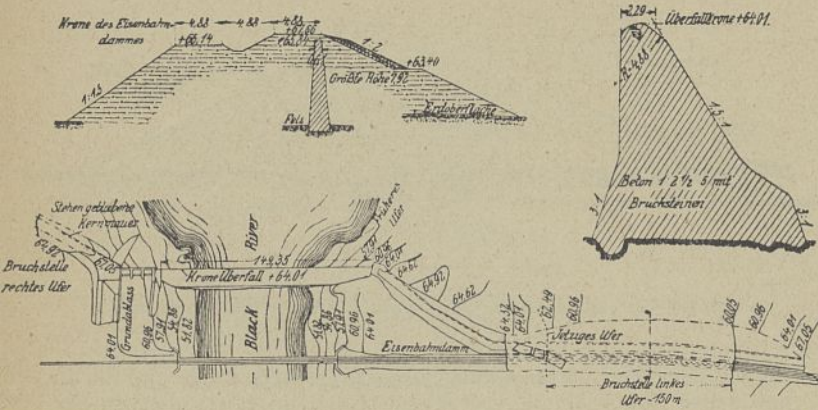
Hatfield-Damm, Lageplan, Dammquerschnitt und Querschnitt der Ueberfallmauer.
